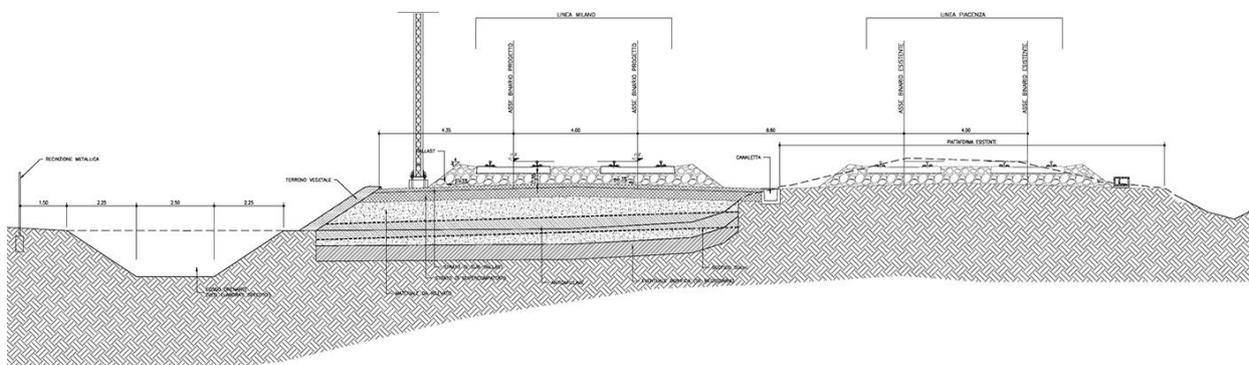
Sezione tipo in rilevato con il quadruplicamento in posizione complanare all'attuale linea
